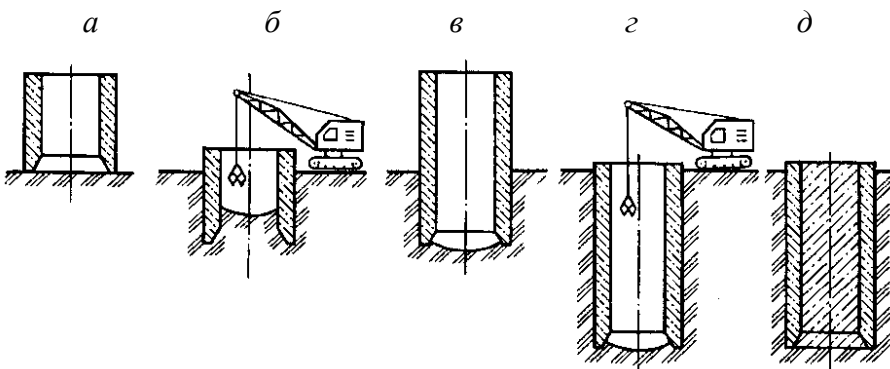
Устройство опускного колодца из монолитного железобетона:
